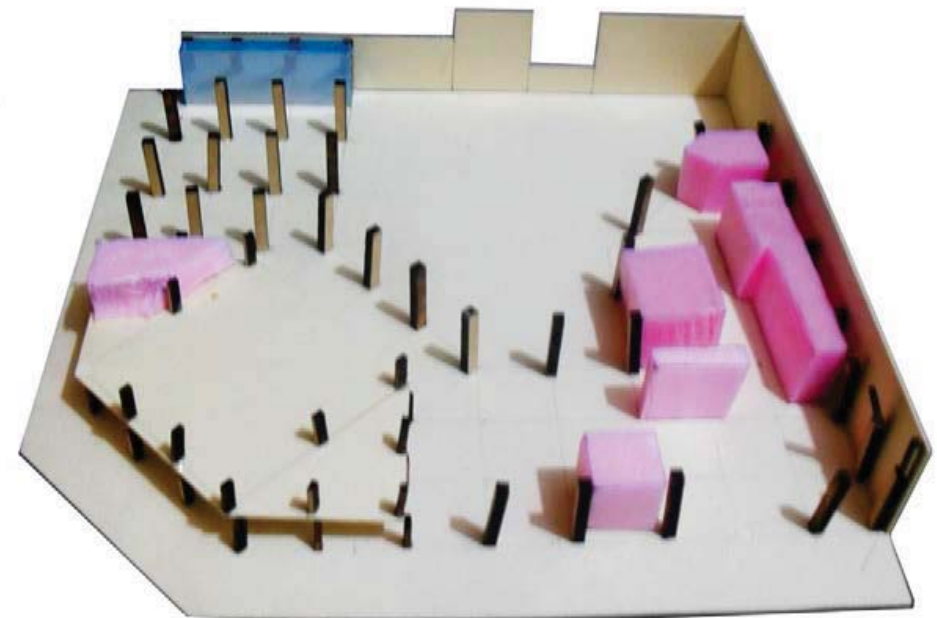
Maqueta conceptual de estructura del planteamiento 1
